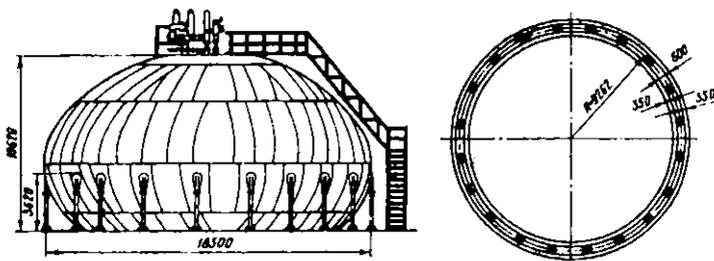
Каплевидный резервуар с экваториальной опорой
